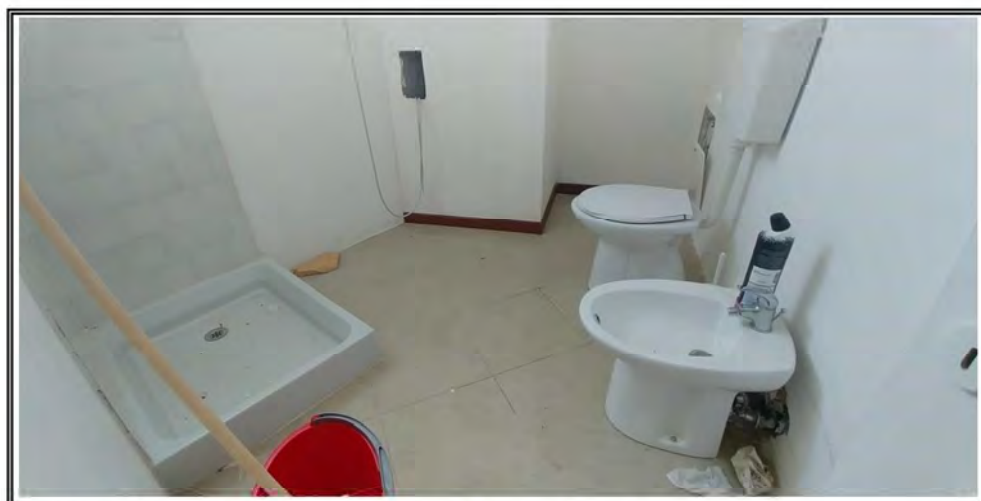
Subalterno 3 – Piano Primo - bagno
